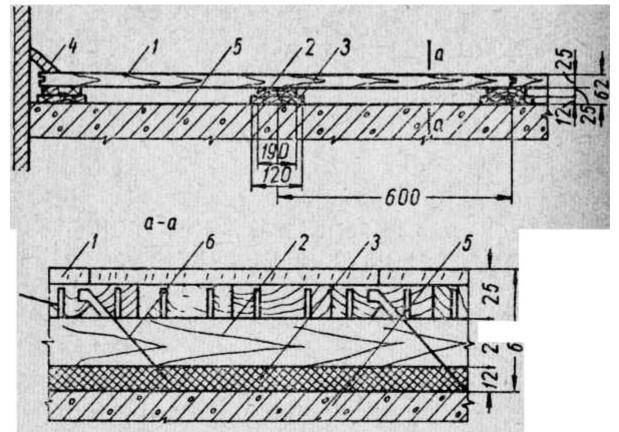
Конструкция пола из паркетных досок по лагам 1- паркетные доски; 2- лаги; 3- прокладка из изолировочно-отделочной древесноволокнистой плиты объемным весом 250-350; 4- галтель; 5- железобетонное перекрытие; 6- гвоздь длиной 60-70 мм
